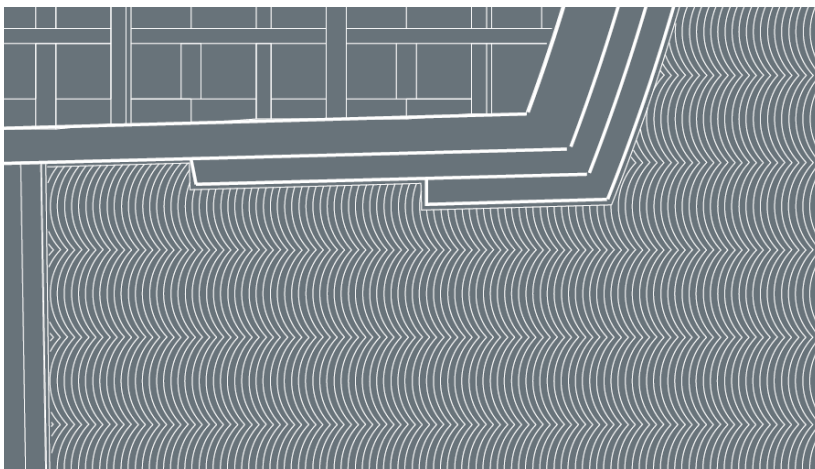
Dekkedetalj sidefelten. Bredder avvikende fra de faste markert med strek, Detaljtegning Next To Nothing.
